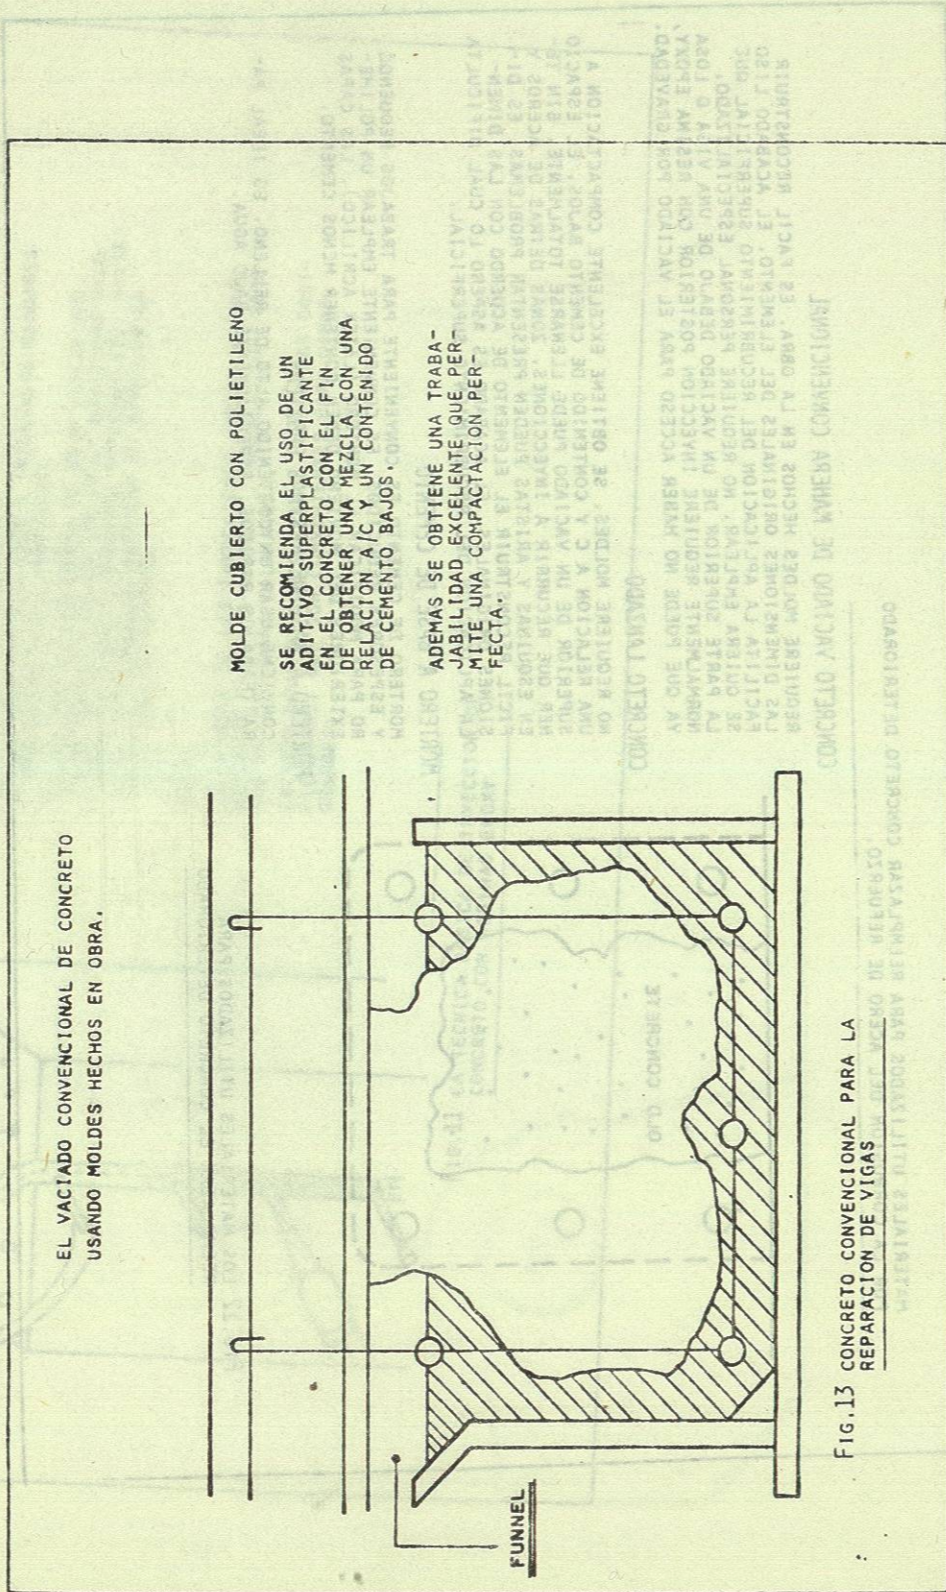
CONCRETO CONVENCIONAL PARA LA REPARACION DE VIGAS
